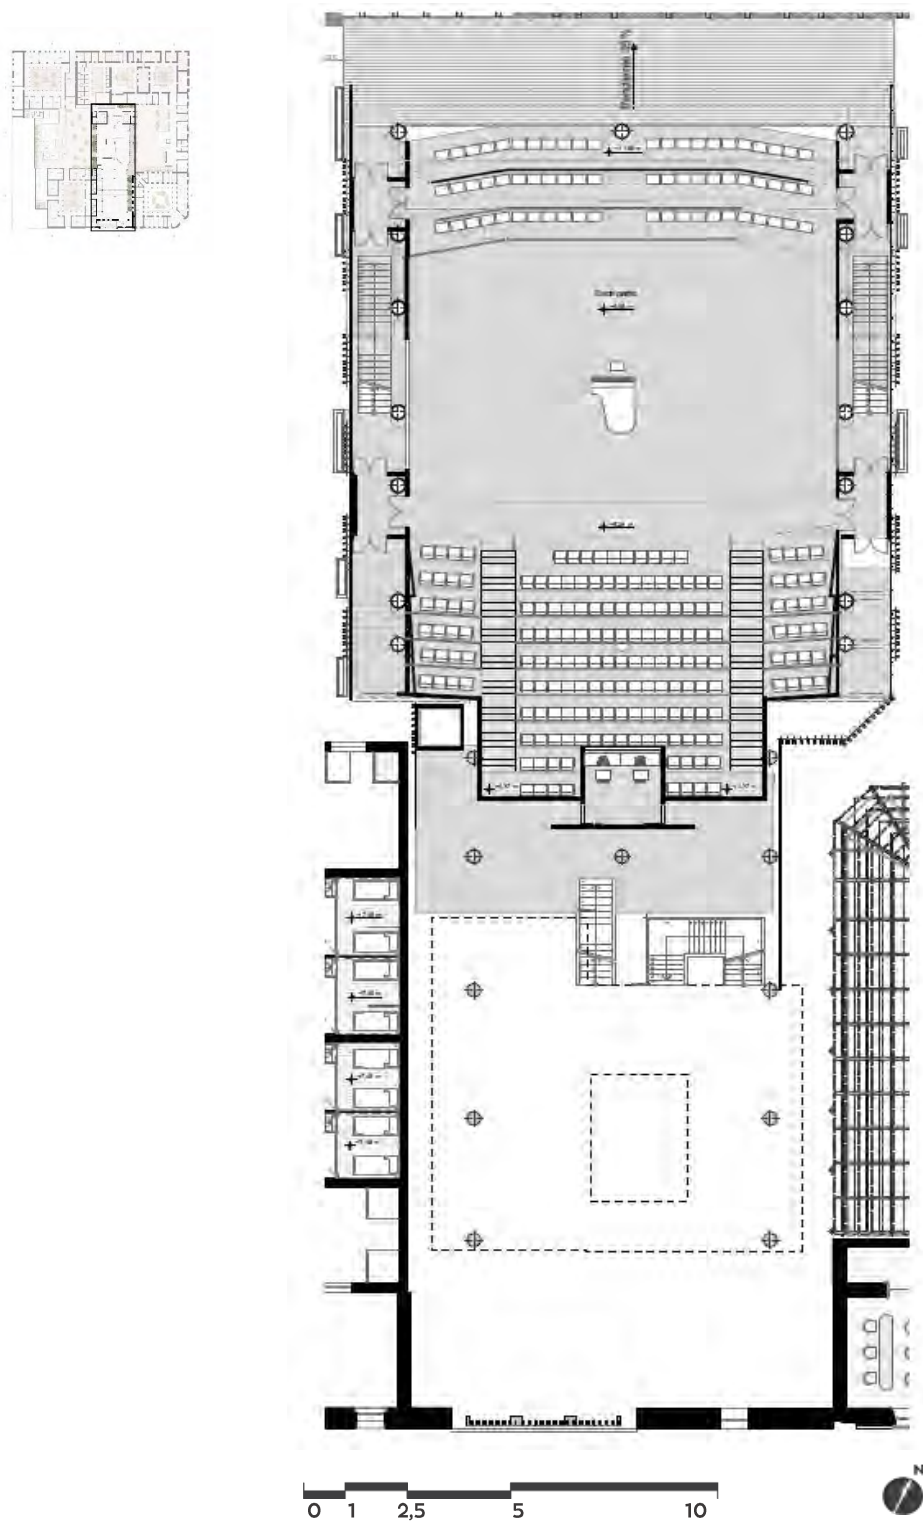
Planta Mezzanine Galería 2. Fuente: Elaboración Propia.
